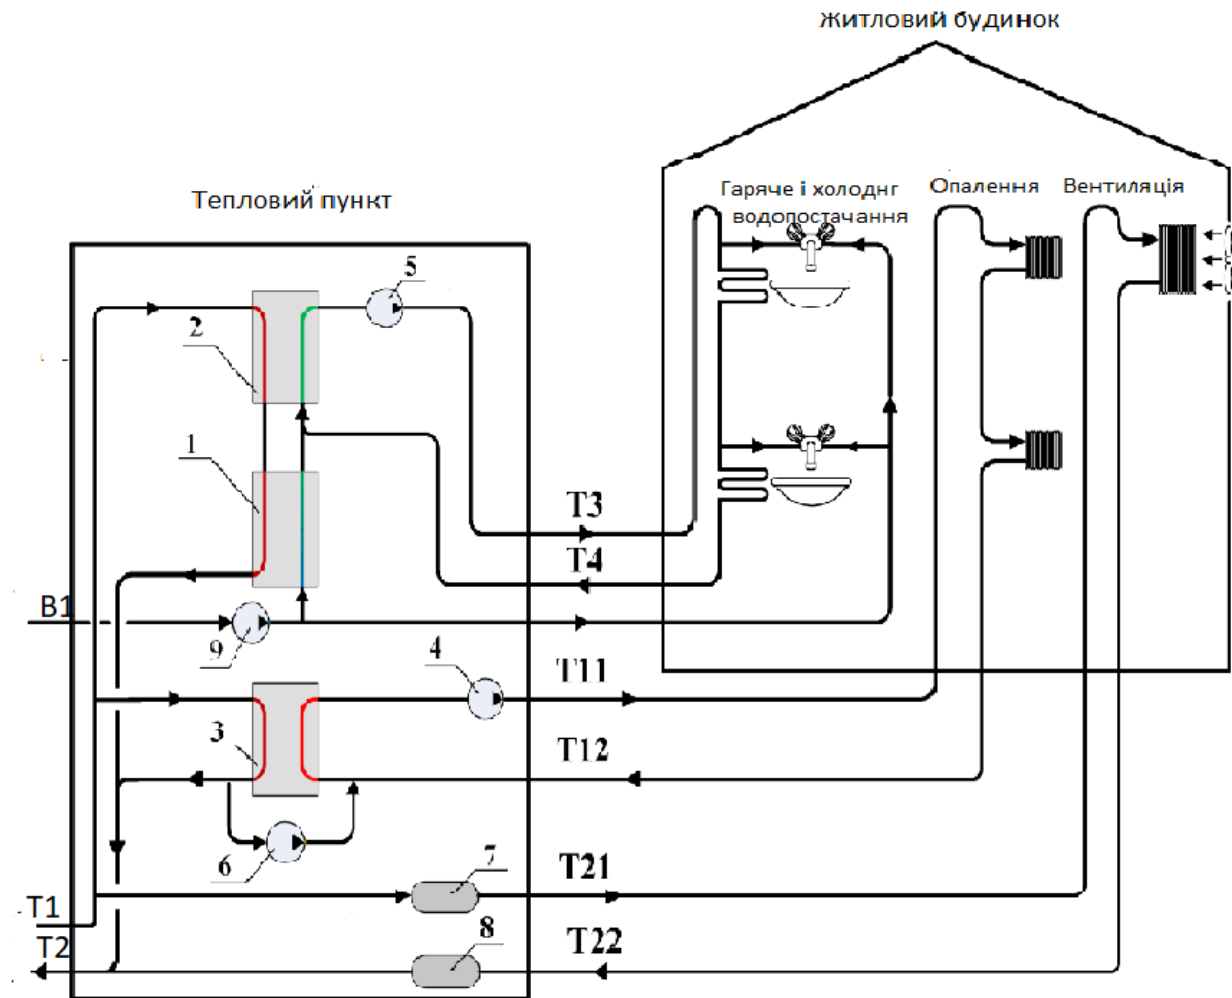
1 – Схема трубопроводів від ЦТП до будівлі:
